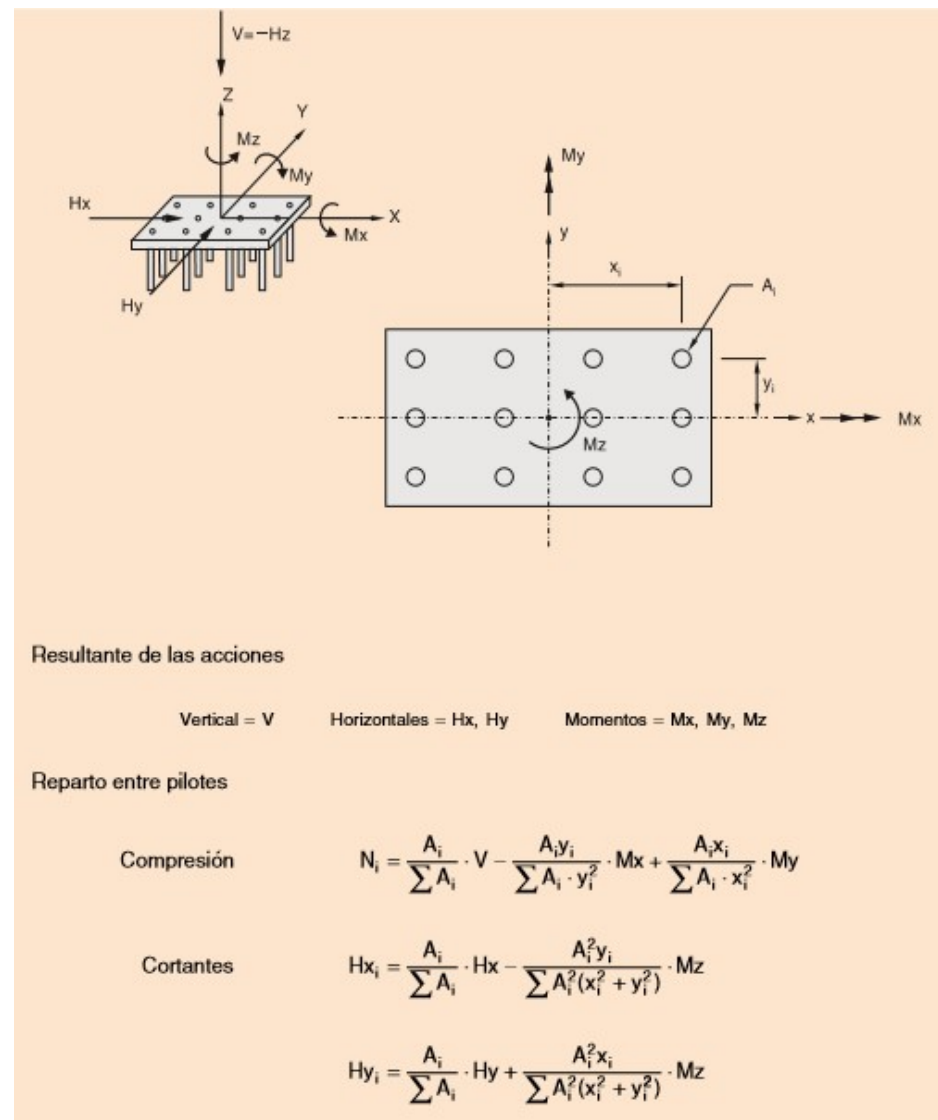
Reparto de esfuerzos verticales y horizontales paralelos al plano del estribo en los pilotes
